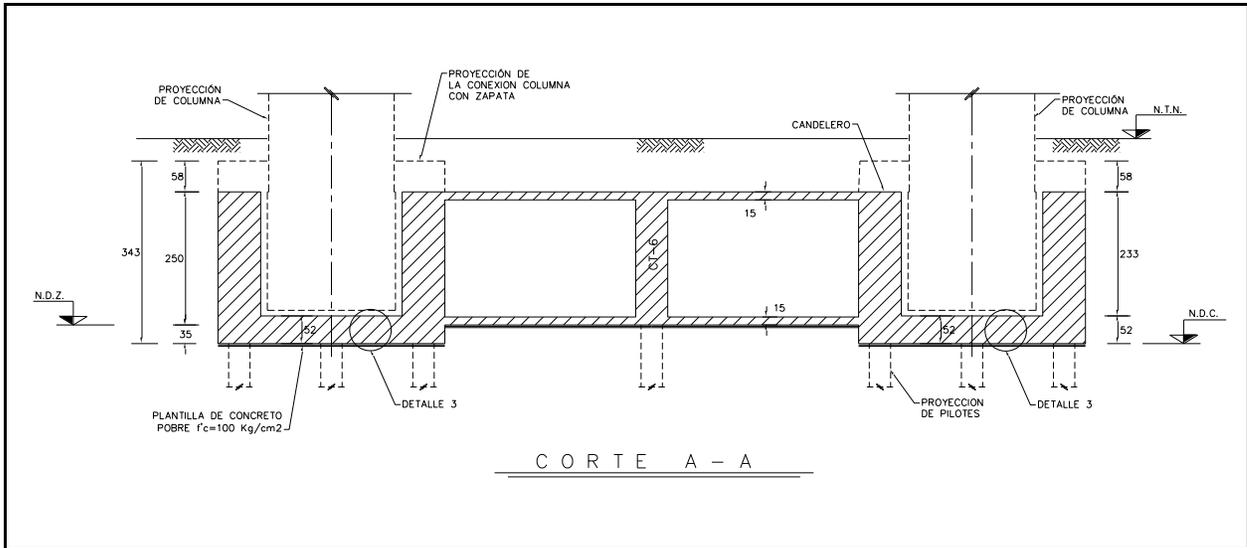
Corte A – A de zapata cuyos ejes de columna son A10 – A11. Todas las acotaciones están en cm, excepto donde se indique otra unidad. Niveles en metros.
